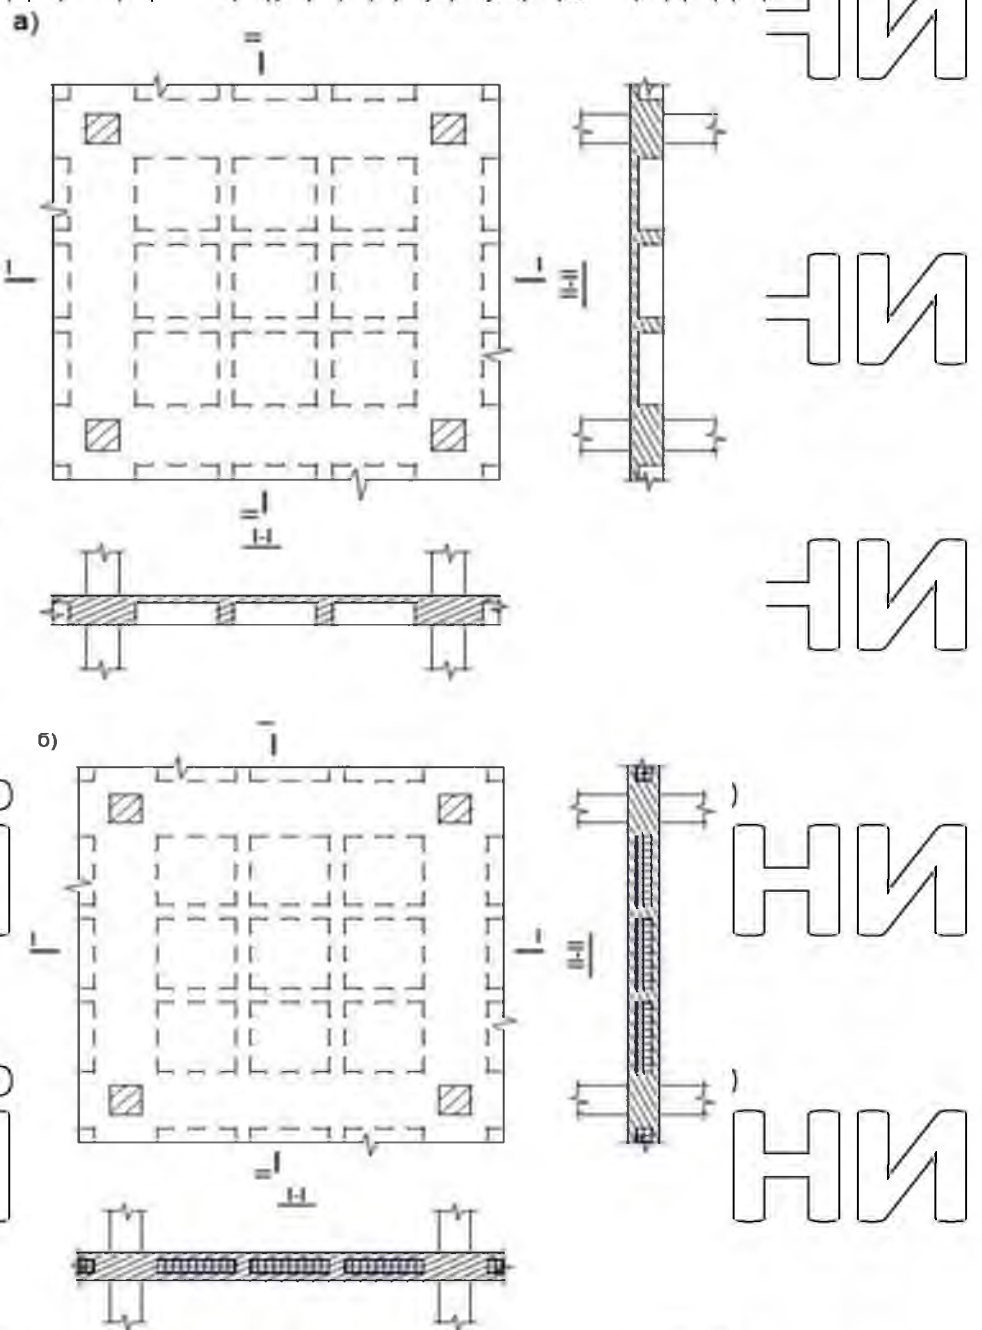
Схеми кесонного (а) і пустотного (б) перекриттів
